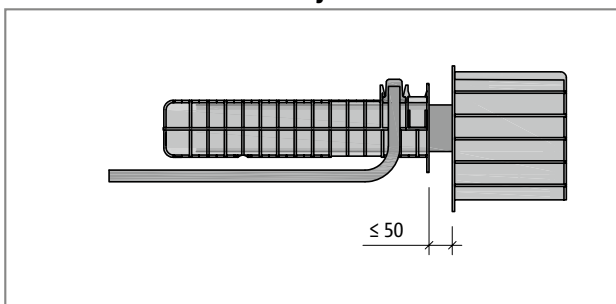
Schöck Tronsole® type Q: Installation variant joint width ≤ 50 mm
